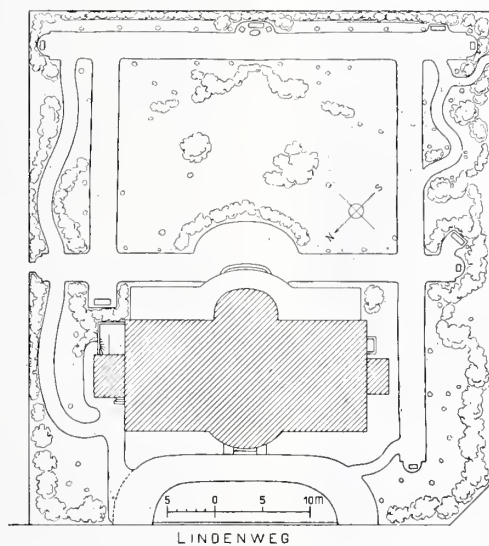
Lageplan des Hauses am Lindenweg. Masstab 1 : 800.
